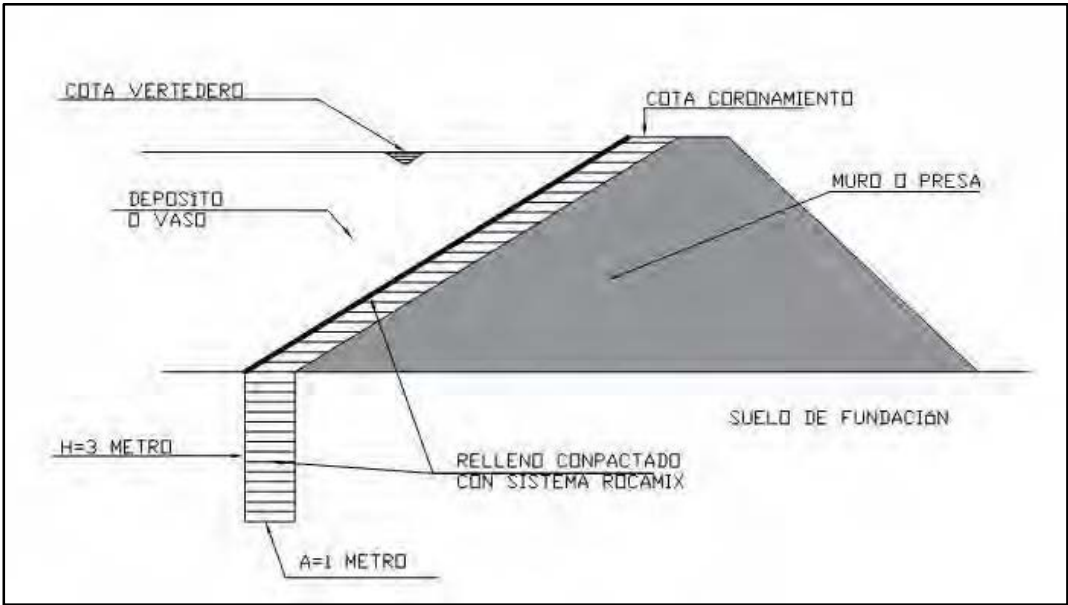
Disposición típica del muro [Fuente: Plano de Muro, Elaboración propia]
